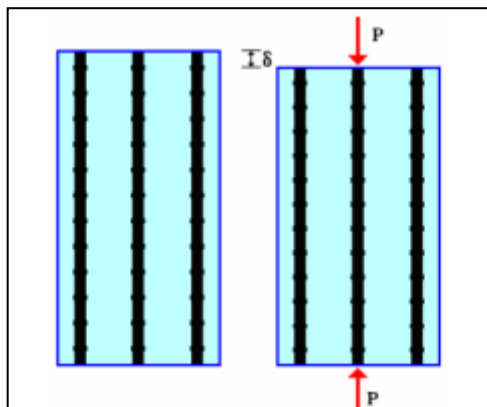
Vista lateral de columna al aplicar fuerza a compresión; Fuente: (Proaño, 2011)
